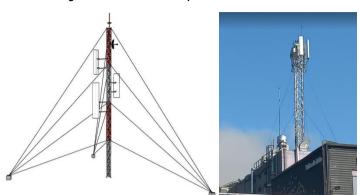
Estructura de Soporte - Torre Arriostrada
